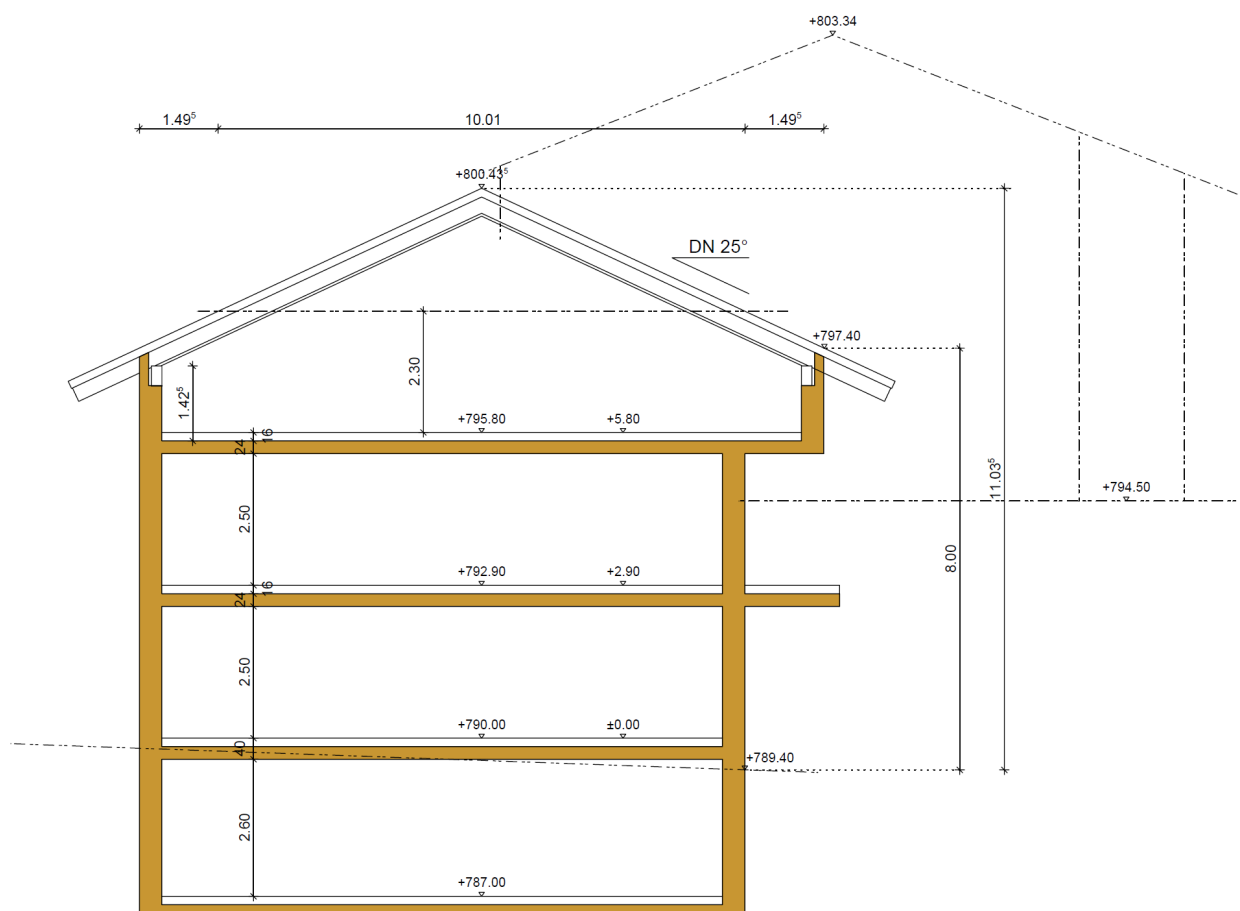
Schemaschnitt des geplanten Bauvorhabens mit hinterliegendem Bestandsbau, unmaßstäblich
